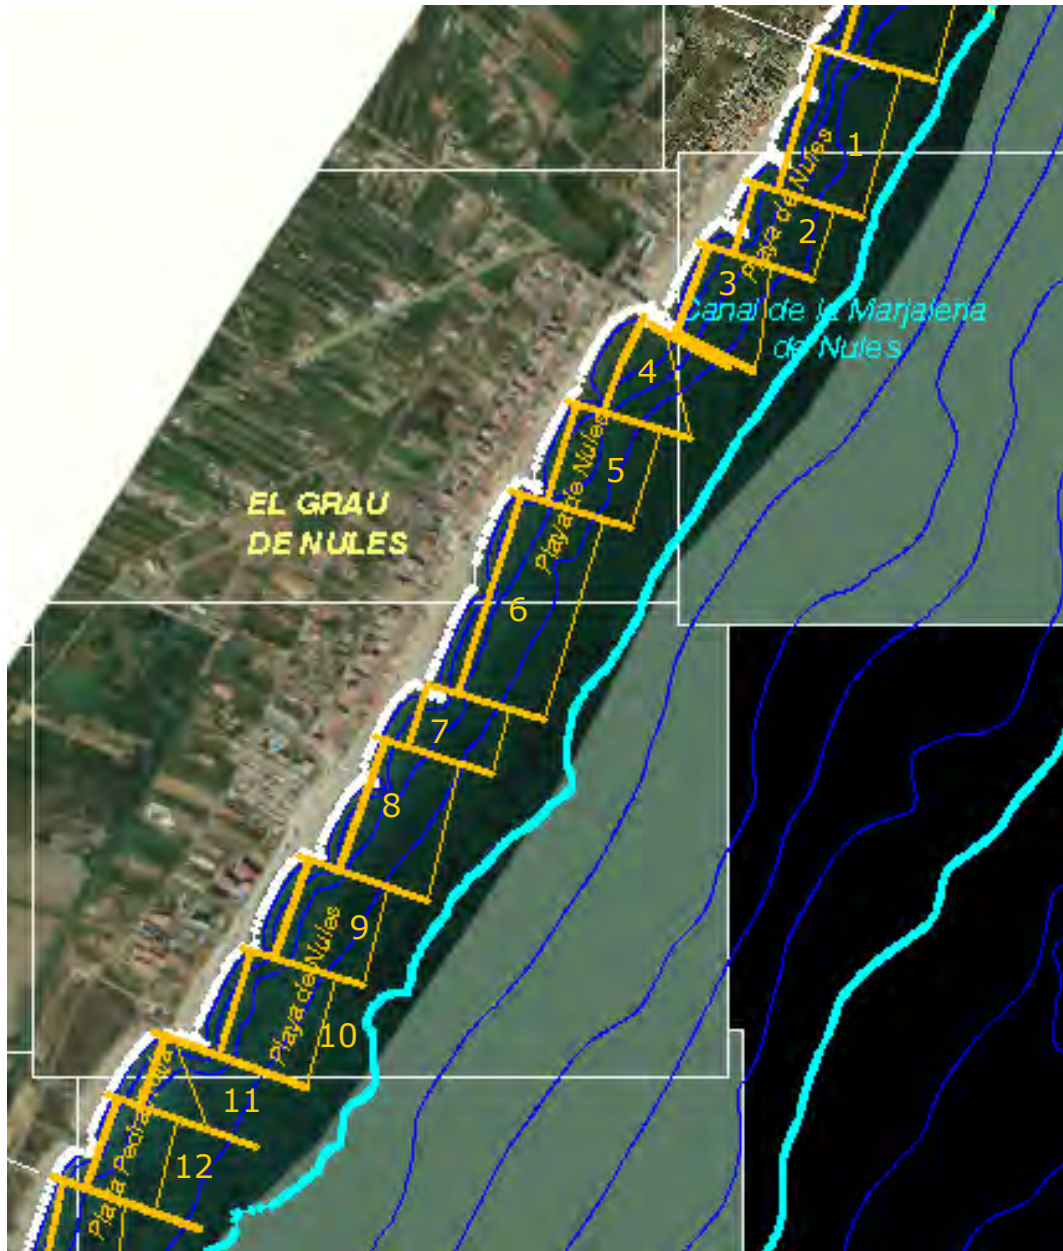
Planta de equilibrio en el tramo 2 de la alternativa 3.2.
